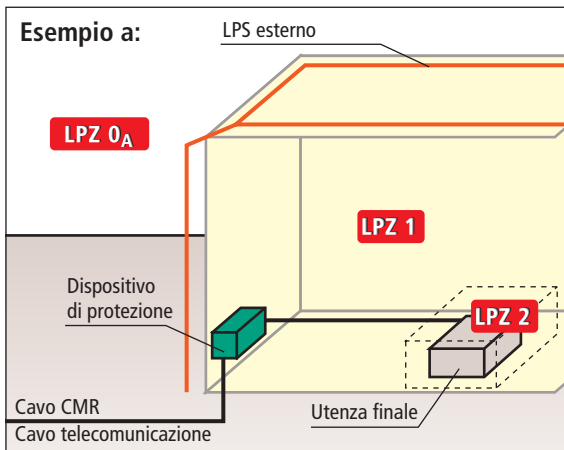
Edificio con LPS esterno e cavi installati tra due edifici secondo il concetto di protezione da fulminazione a zone
